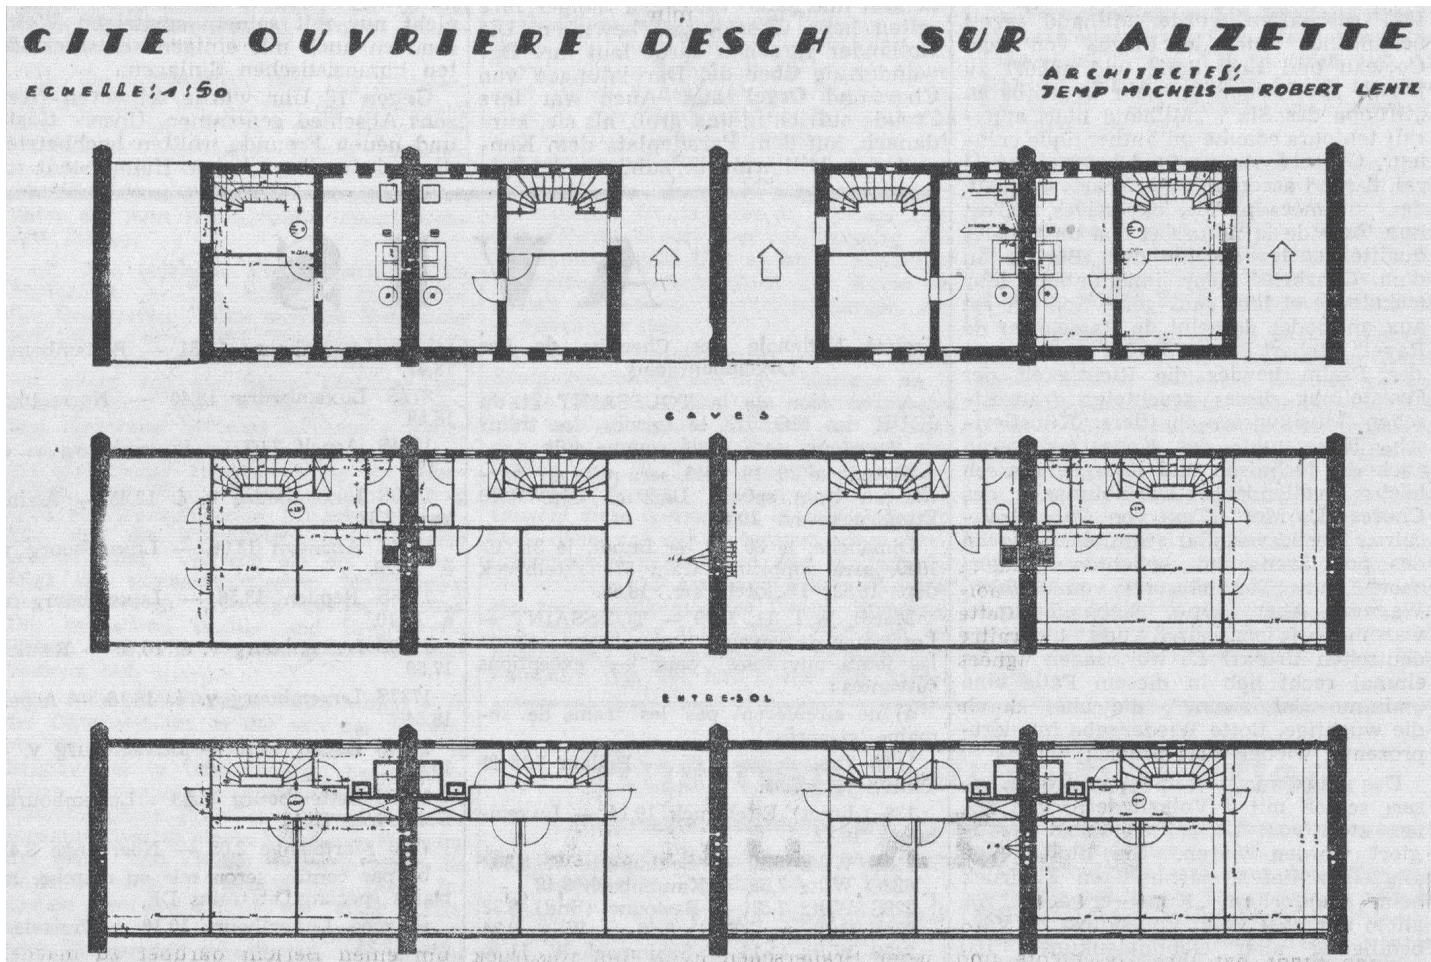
Grundrisse einer Häuserreihe (um 1949)
